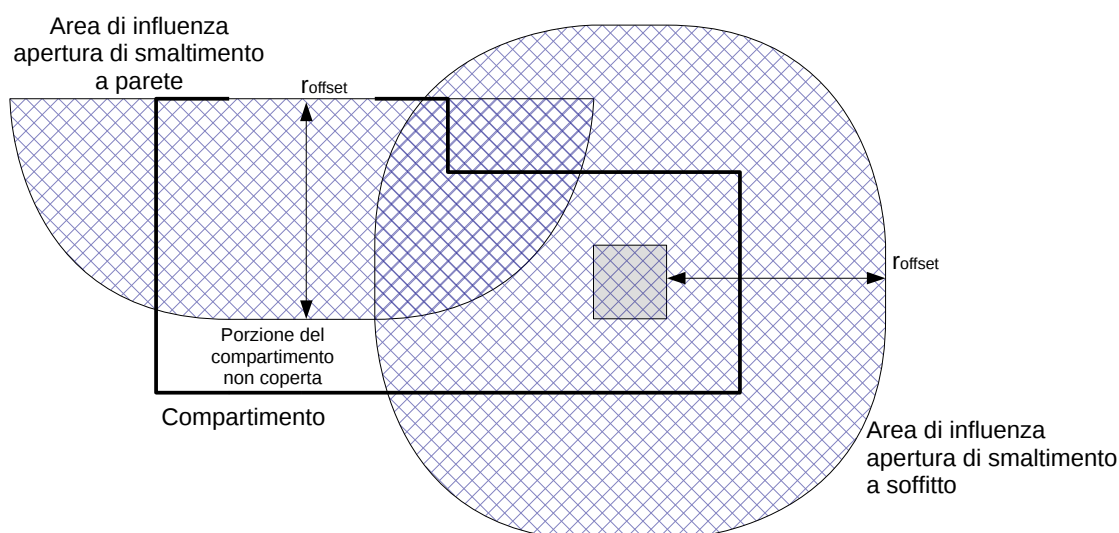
Verifica dell'uniforme distribuzione in pianta delle aperture di smaltimento
